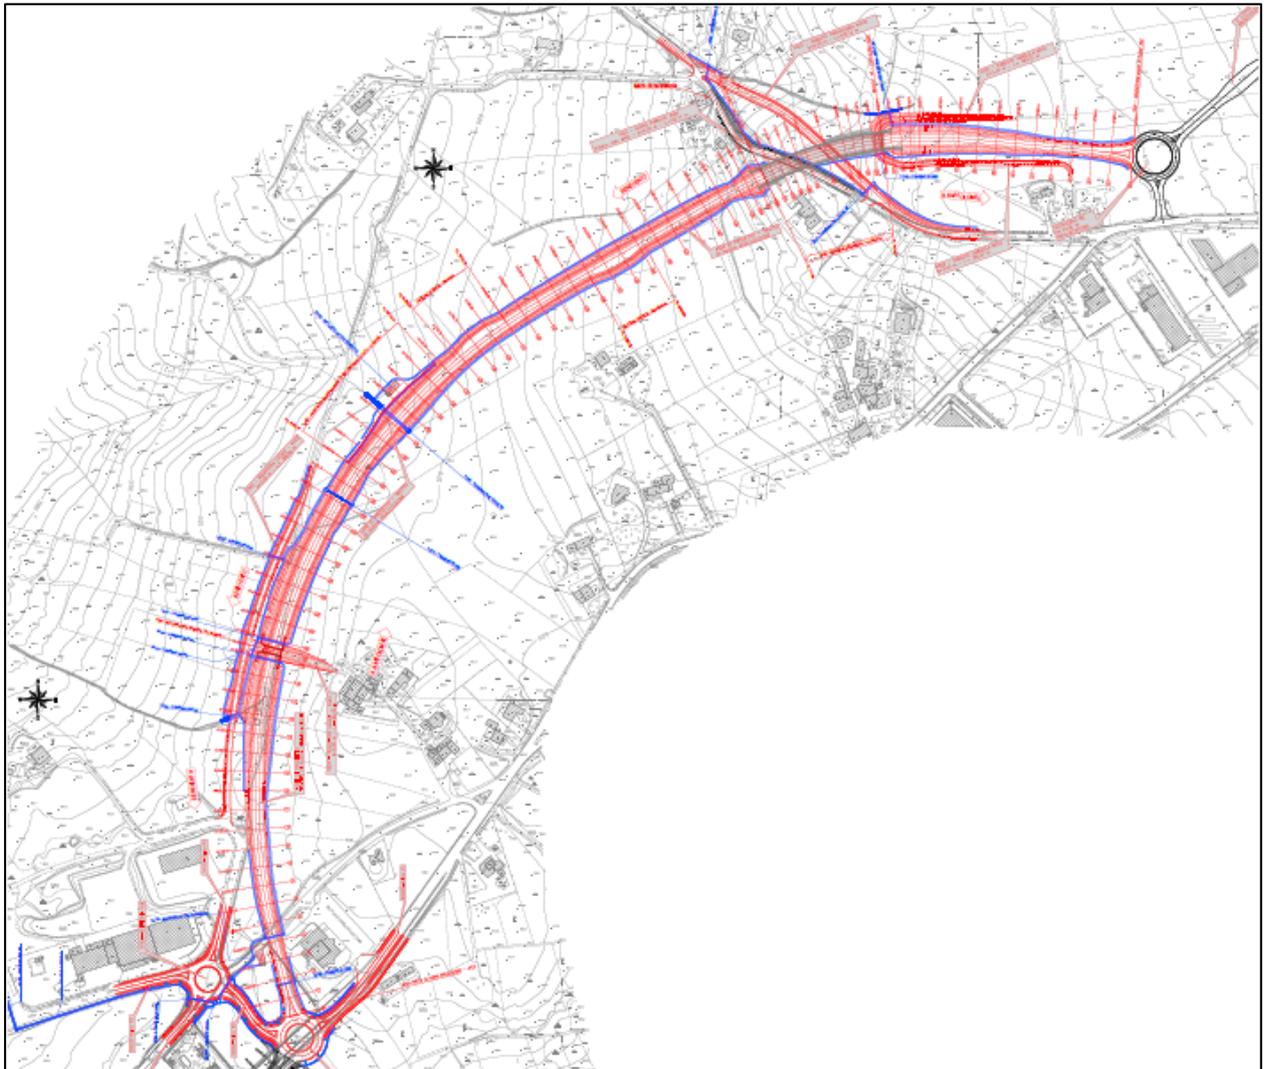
Planimetria di progetto tratto di nuova realizzazione
